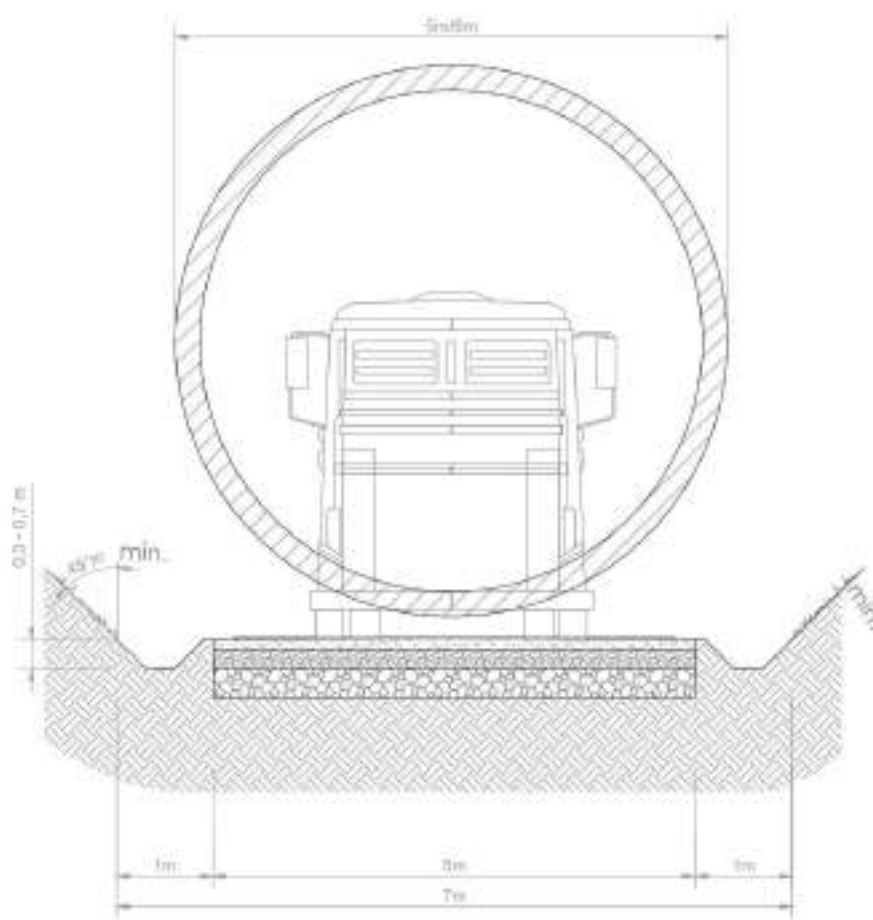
Sezione stradale tipo con rappresentazione dell'ingombro trasporto
